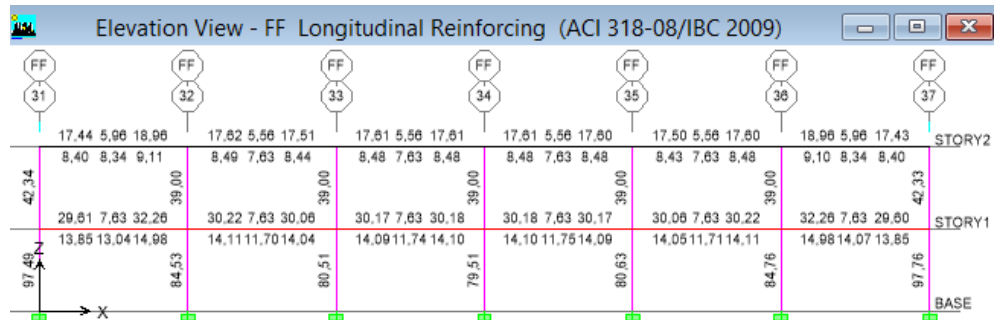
Acero en Vigas y Columnas en el Pórtico FF – Obstetricia - (NEC-11)
